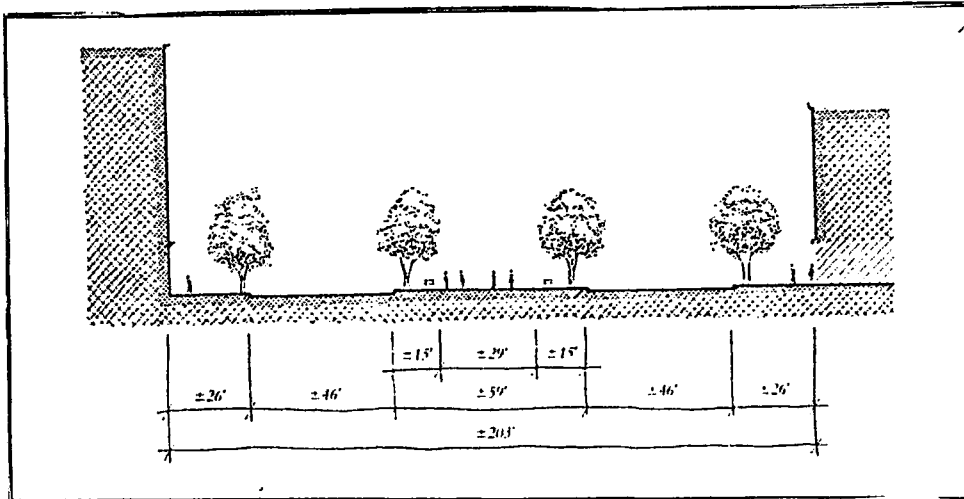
Rambla de Catalunya Caddesi - Plan (Ölçek: 1/600)
